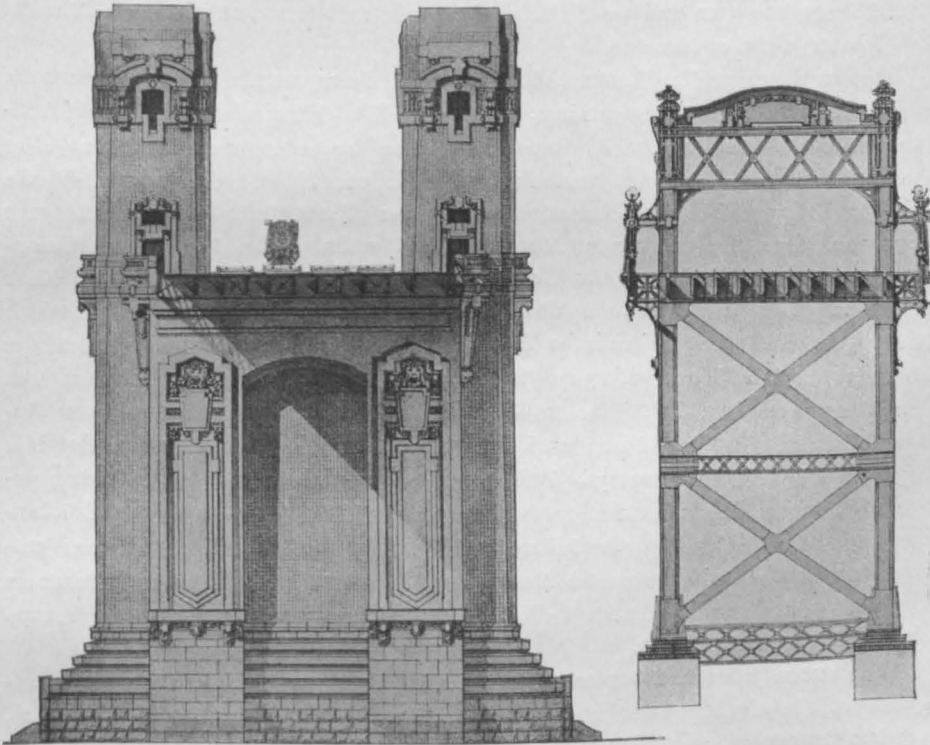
Querschnitte vom Plane der Hell Gate-Eisenbahnbrücke in New York.
